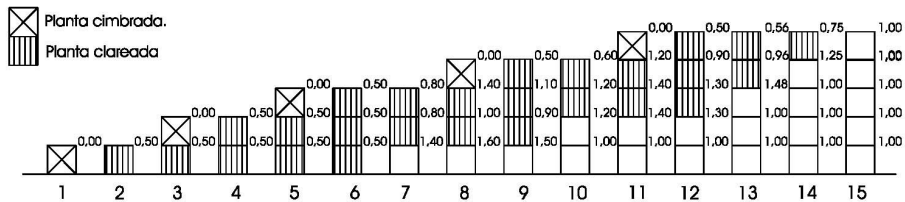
Valor del coeficiente "k" obtenido de la secuencia constructiva, 1 planta cimbrada y 2 plantas clareadas.
